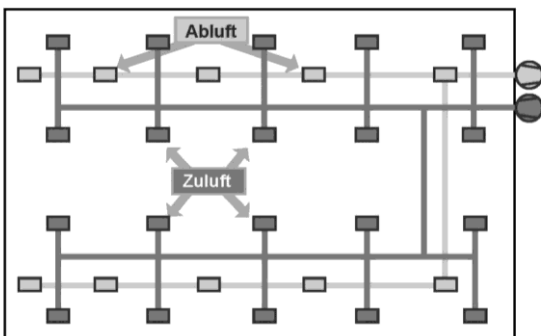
Anlagenschema einer Lüftungsanlage im Entrauchungsbetrieb mit einer Entrauchungsleitung (Lüftung - Zuluft)
